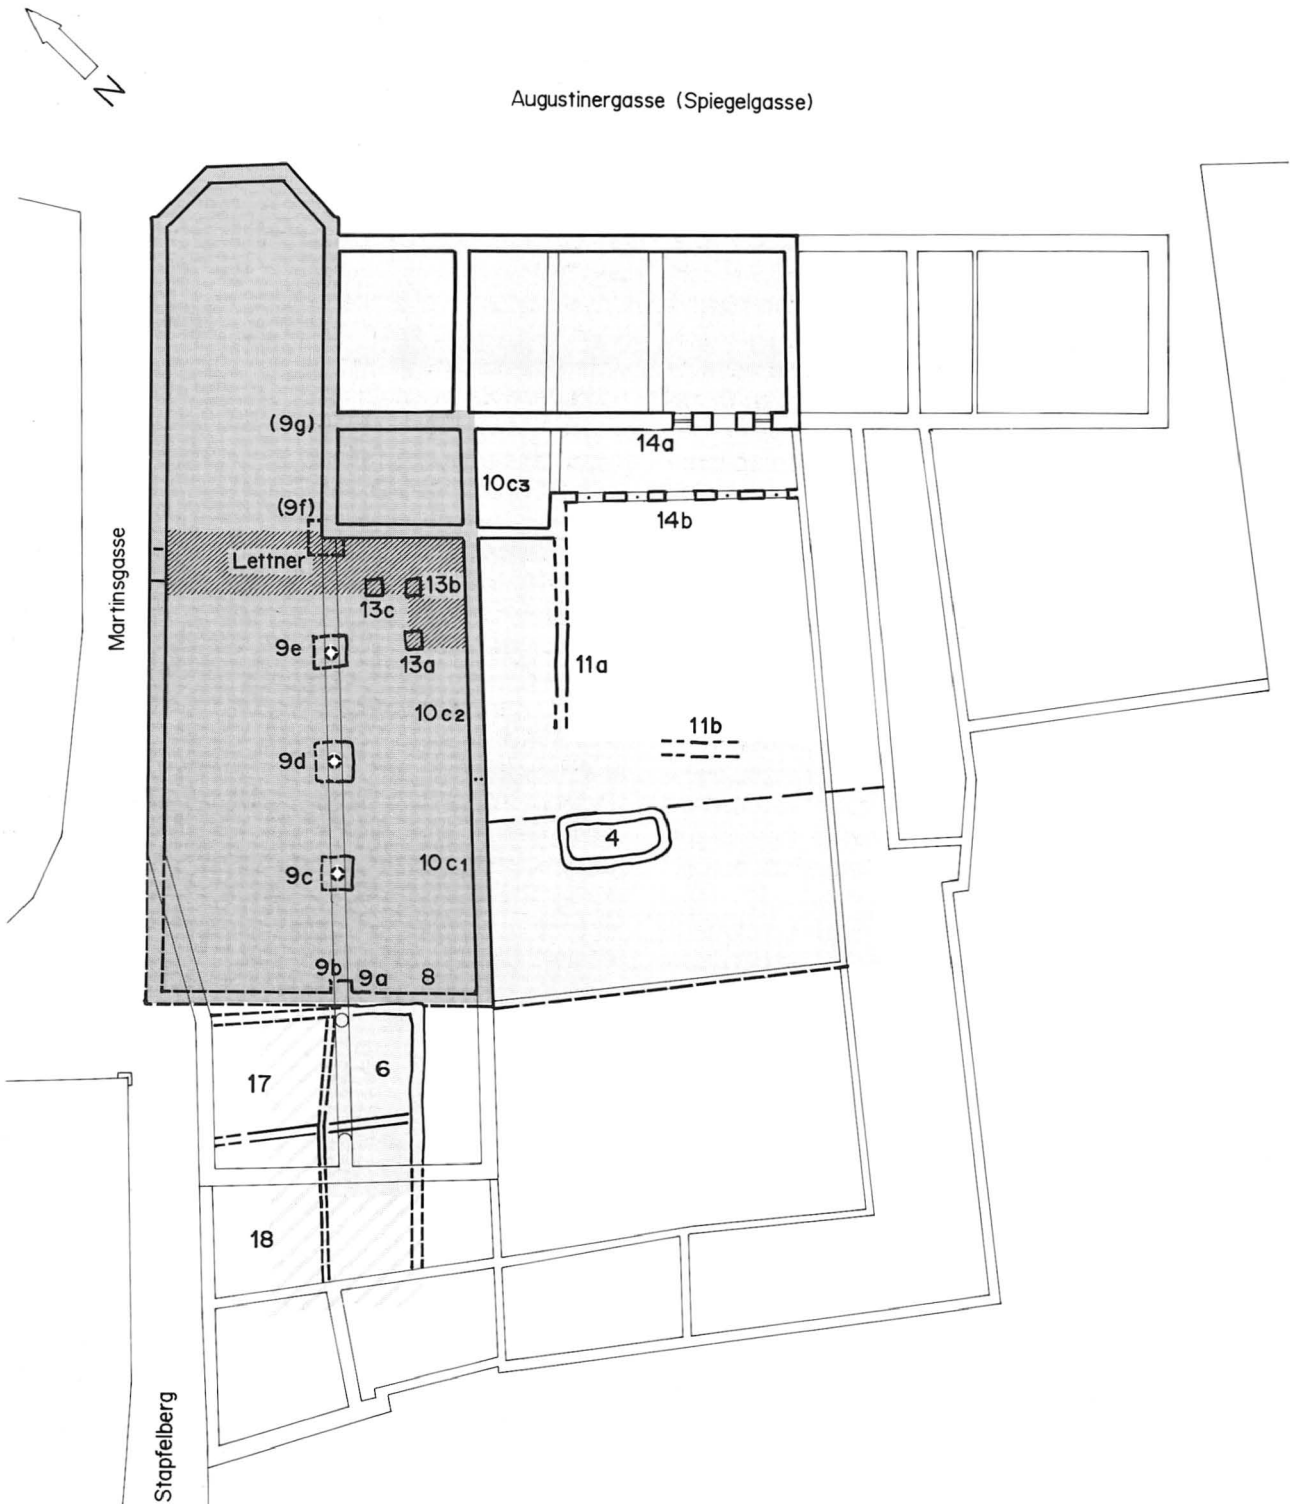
Grundriss des Klosters um 1290/1300 bis 1320 (Kirche Ib). Rekonstruktion. – Massstab 1:400.
